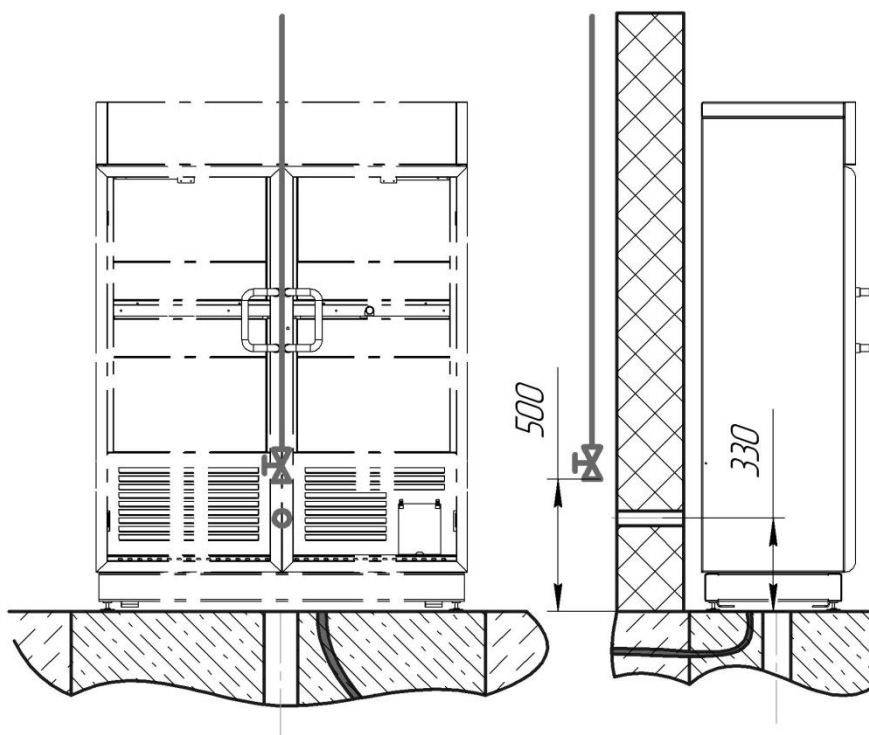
Схема расположения запорной арматуры на внутренней отделке стены здания АЗС
